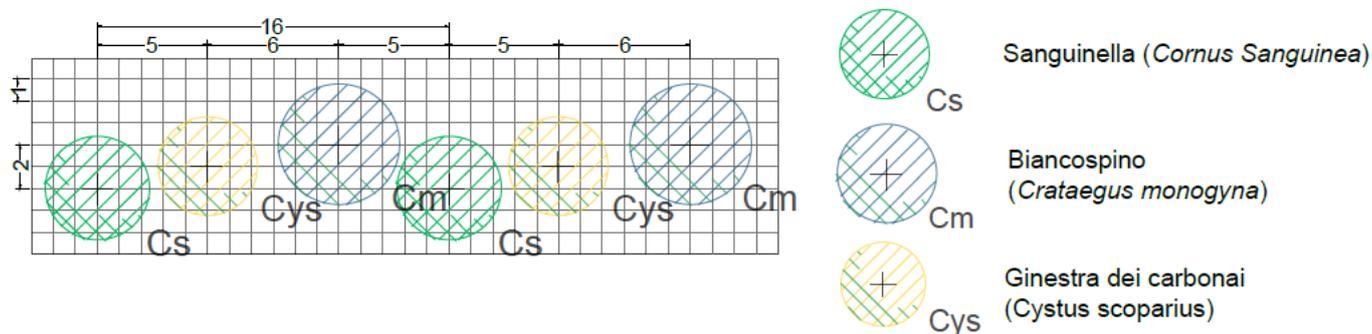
SESTO D'IMPIANTO PREVISTO PER L'INTERVENTO SA
